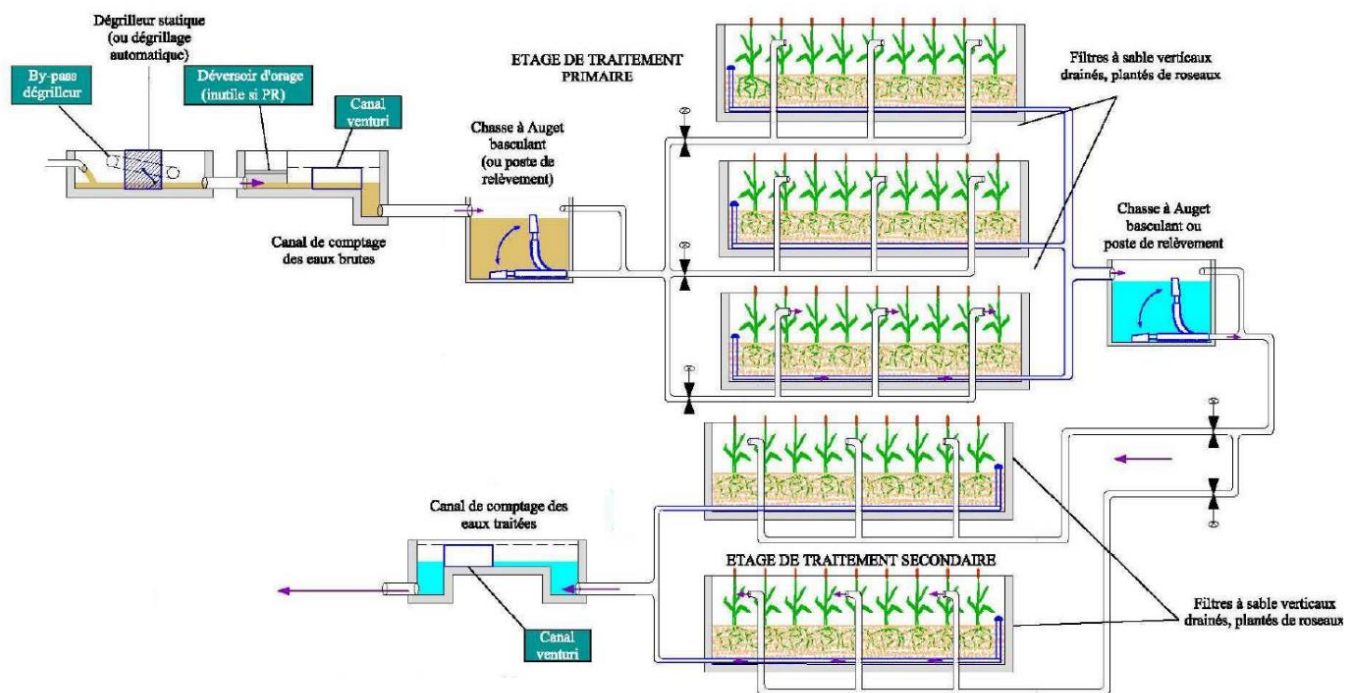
Vue en coupe d'une station de traitement par filtres plantés de roseaux verticaux
